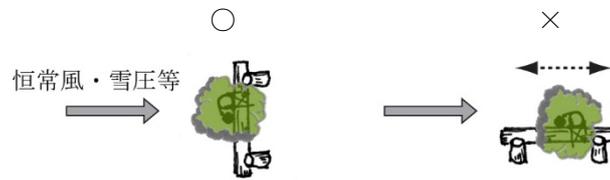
受圧方向に対する支柱の設置方向模式平面図
